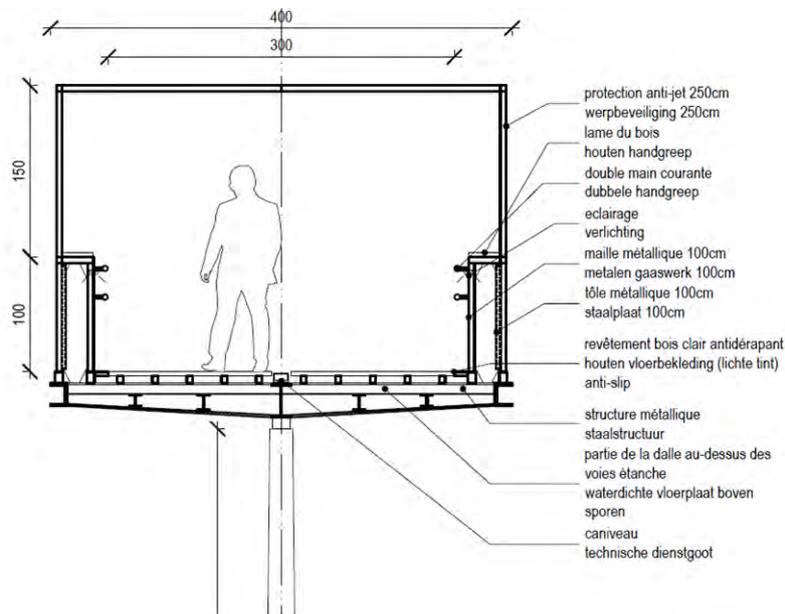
Coupe transversale de la passerelle au niveau de la protection anti-jet (BMN, 2018)
